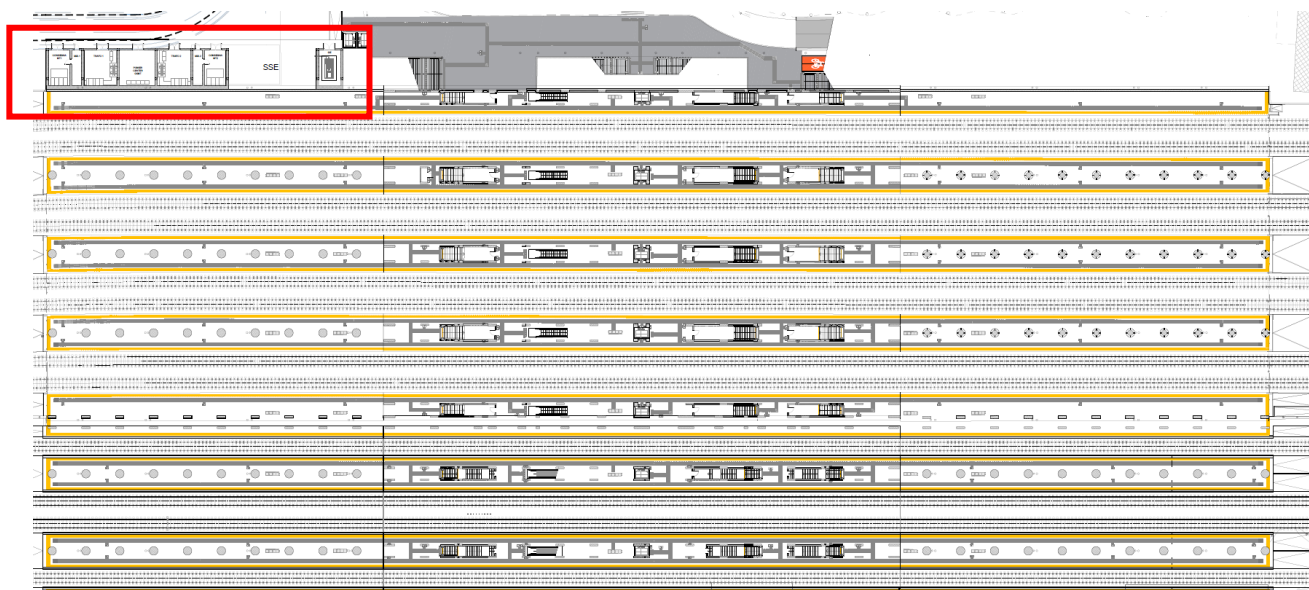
Pianta Piano Banchine con indicazione della Cabina di stazione.
